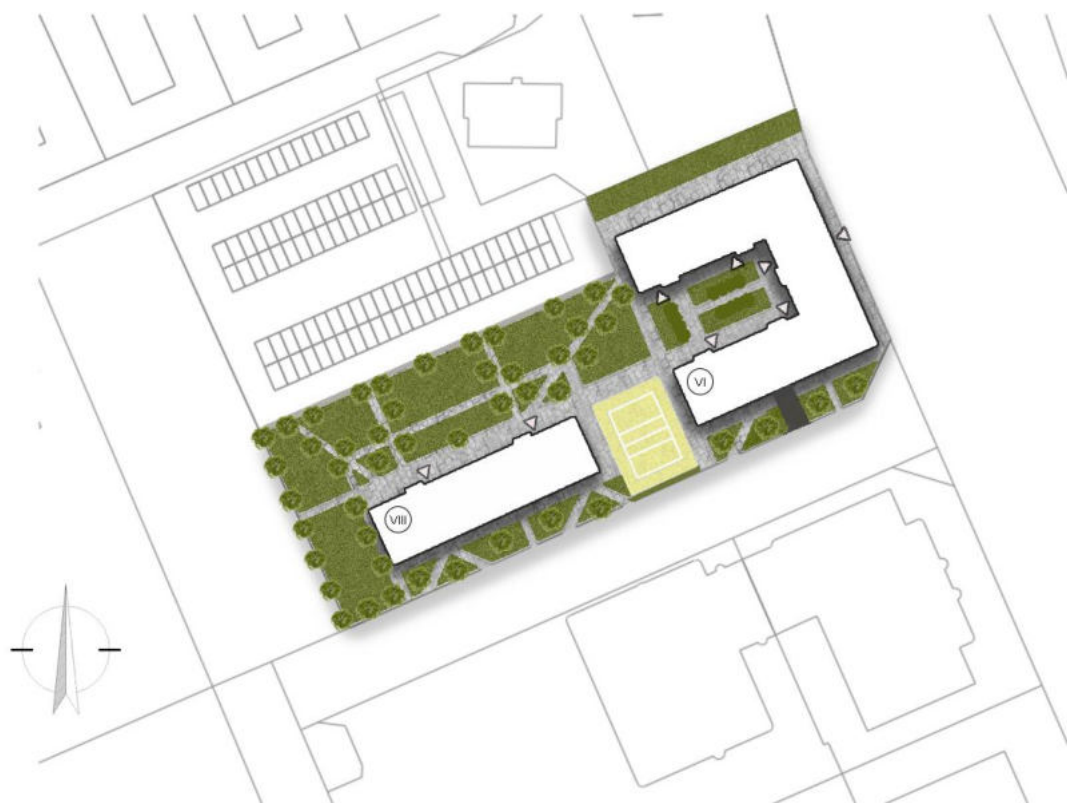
Wizualizacja projektowanej małej architektury. Opracowanie własne
